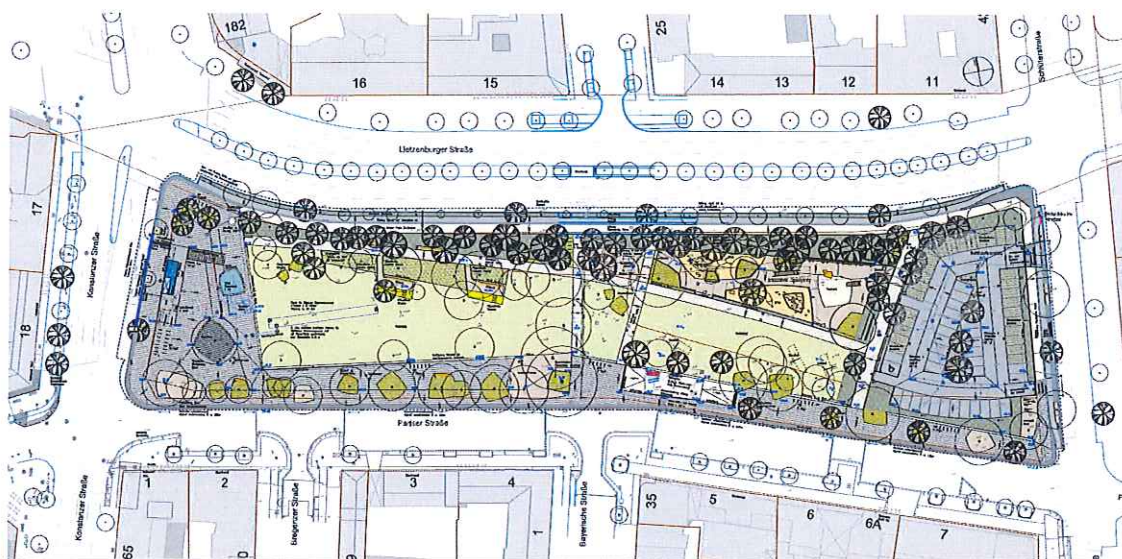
Lageplan Olivaer Platz, Stand März 2016 (Entwurf)
